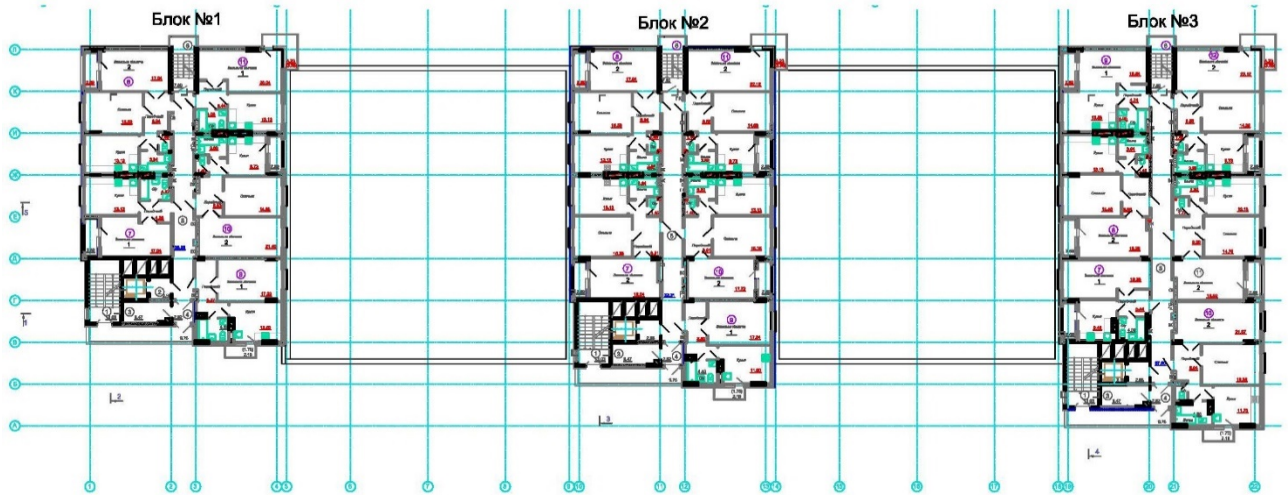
План типового поверху (з 3-го по 9-й)
